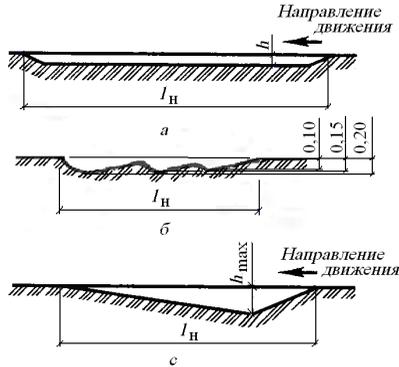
Схемы резания грунта бульдозером: а – прямоугольная; б – гребенчатая; в – клиновая
